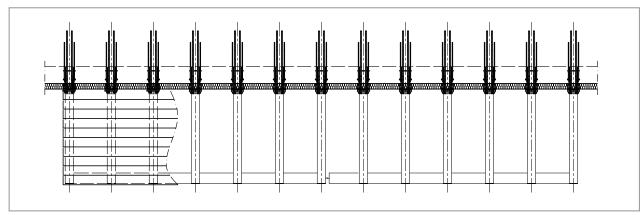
Schöck Isokorb® T tipo SK: Balcón en voladizo
